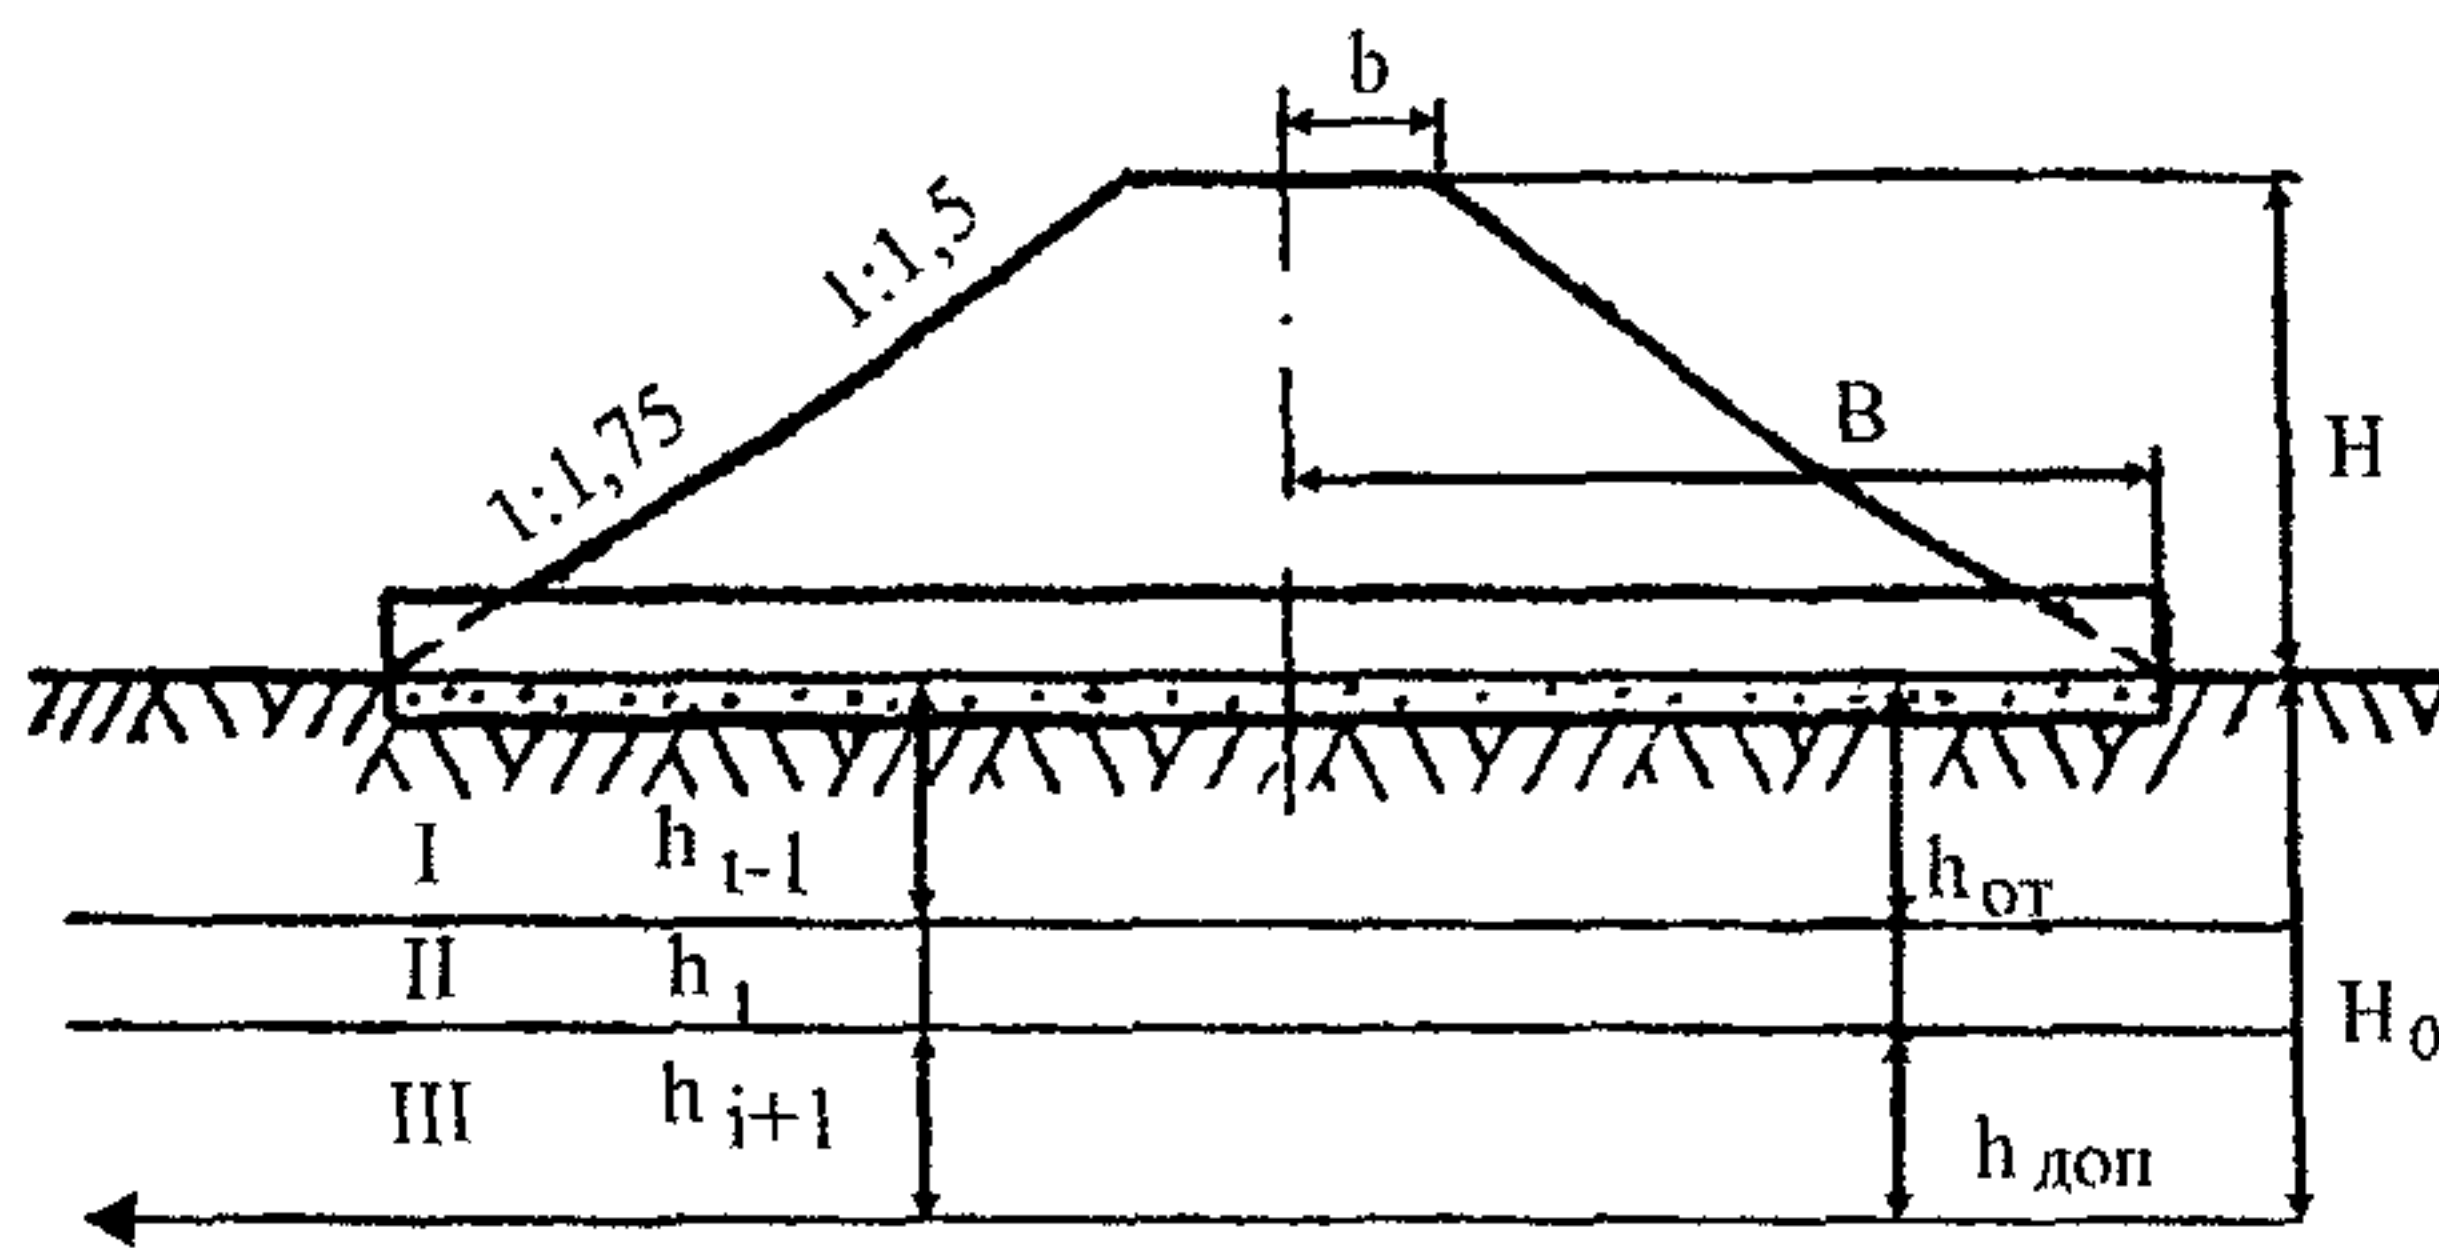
Схема к расчету осадок труб на оттаивающих грунтах
